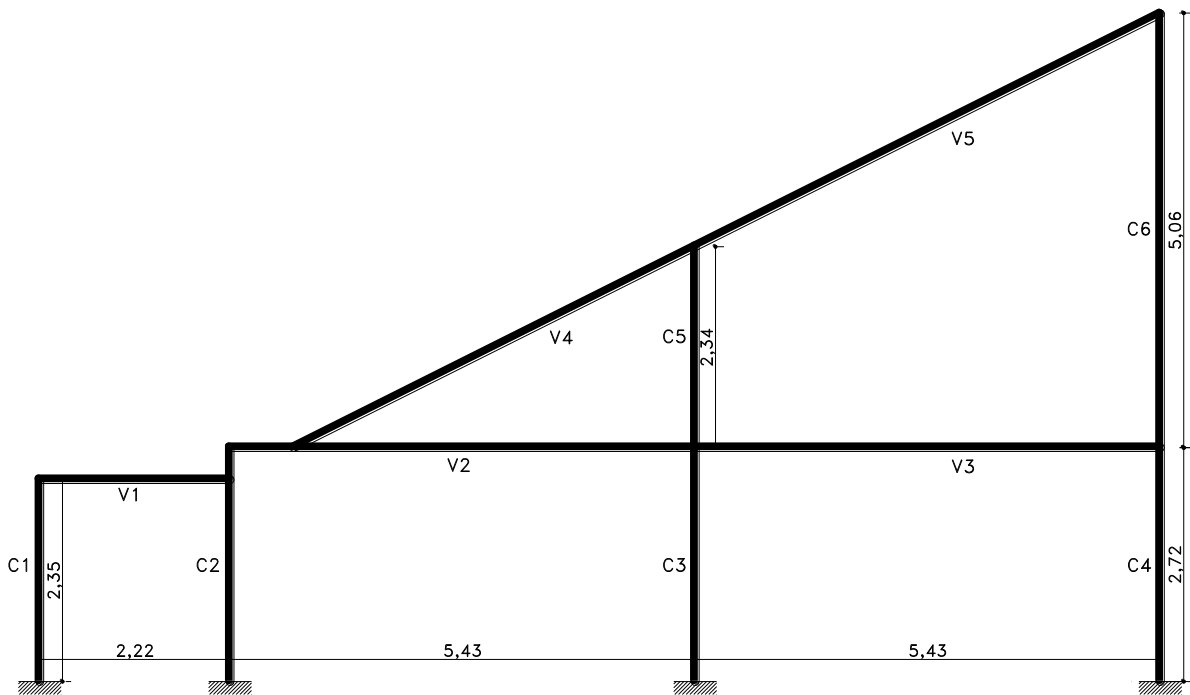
Pórtico bajo tribuna – Esquema estructural
